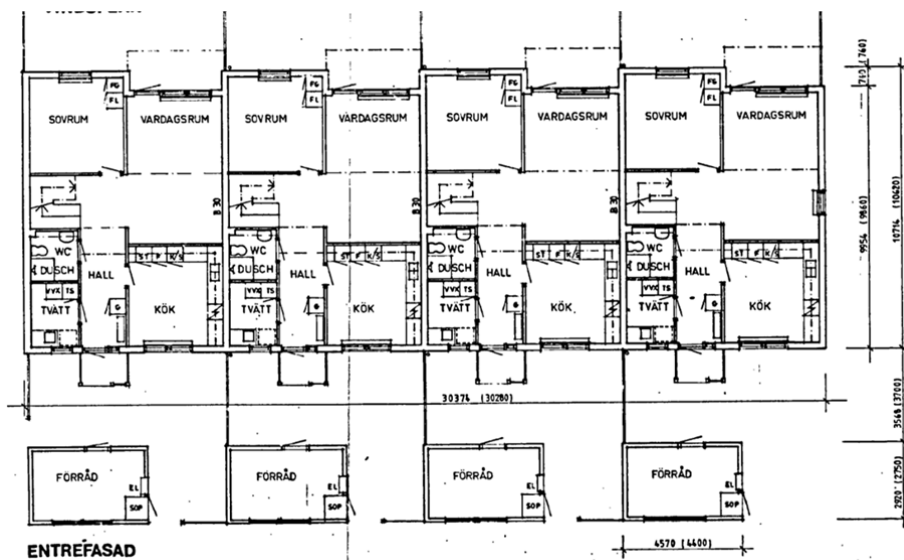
Planritning radhuslänga 1, entréplan. Brandavskiljning mellan lägenheter anges vara i klass B30.
